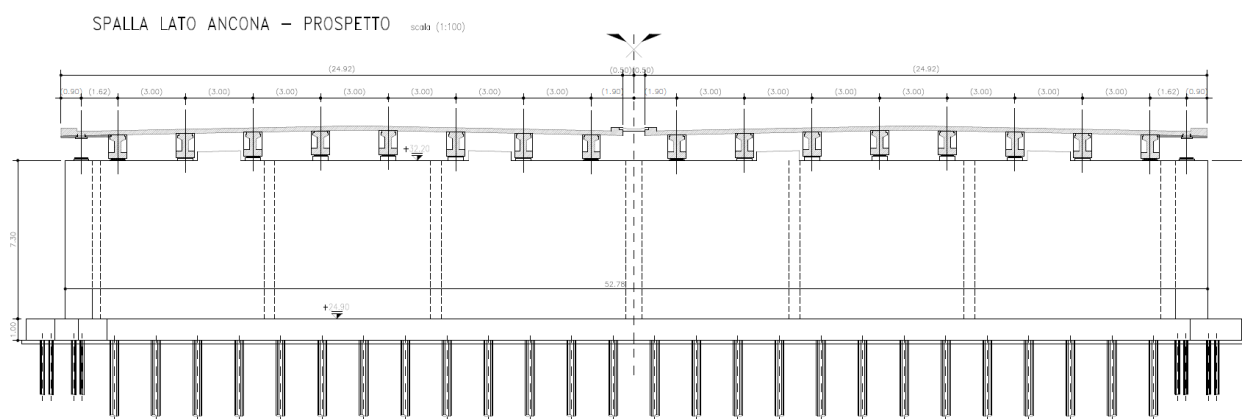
Sezione trasversale Spalla lato Ancona
